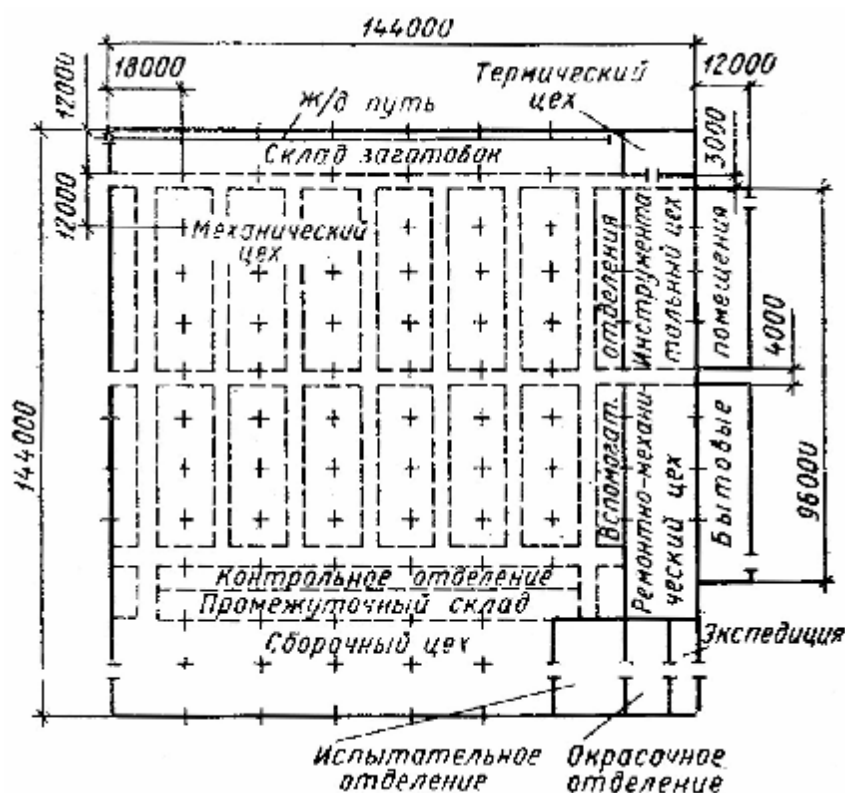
Схема компоновки нескольких цехов и склада металла и заготовок в одном корпусе
